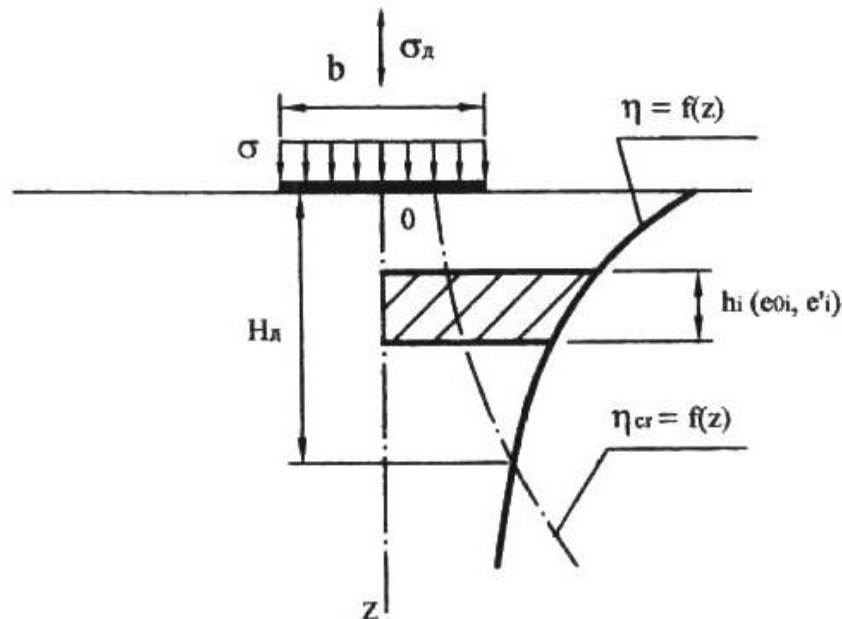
Розрахункова схема визначення віброущільнення ґрунтів основи фундаменту
